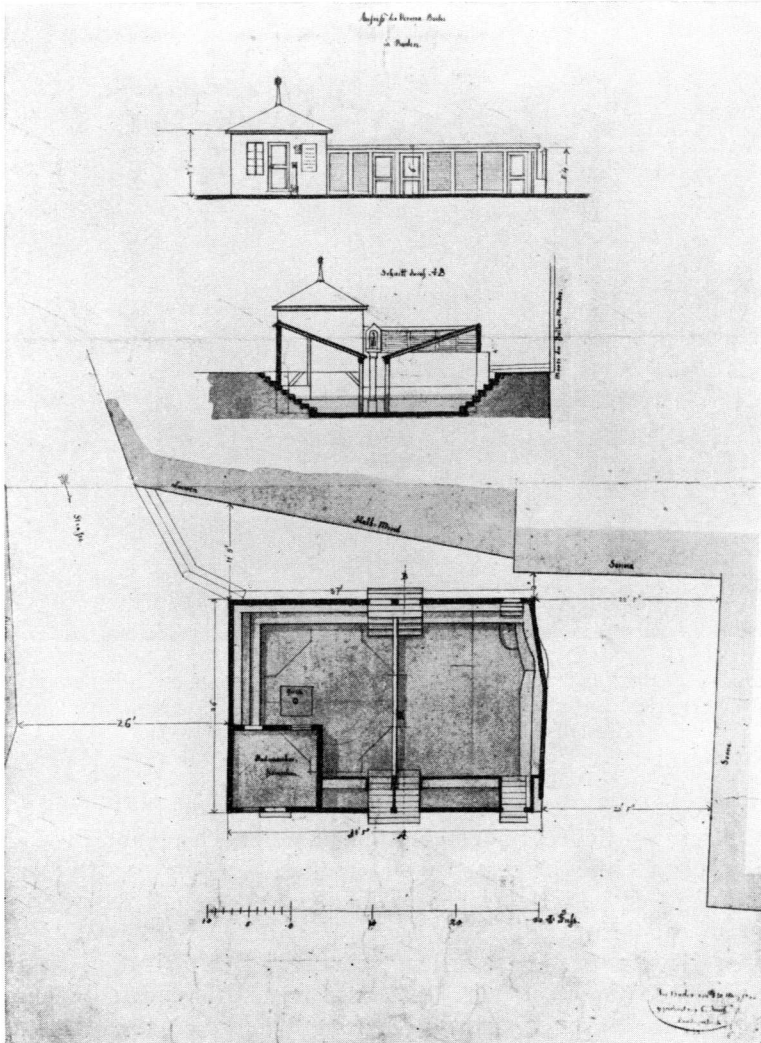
Grundriß und Schnitt durch das Verena-Bad kurz vor dem Abbruch 1844
